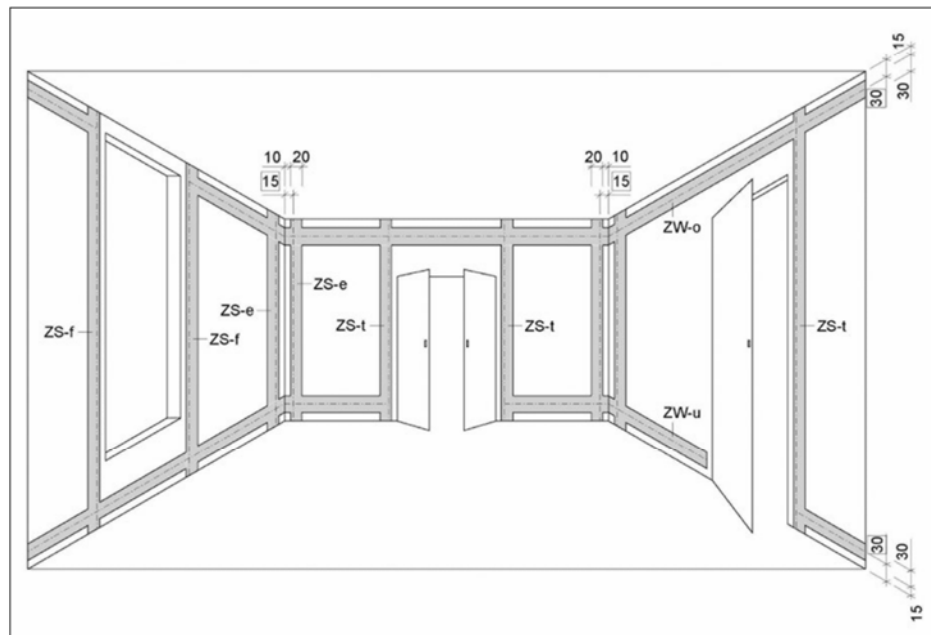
Installationszonen und Vorzugsmaße (im Kasten) für Elektroinstallationen in Räumen (DIN 18015-3). Gilt nicht für Räume mit Arbeitsflächen an Wänden z. B. Küchen.
